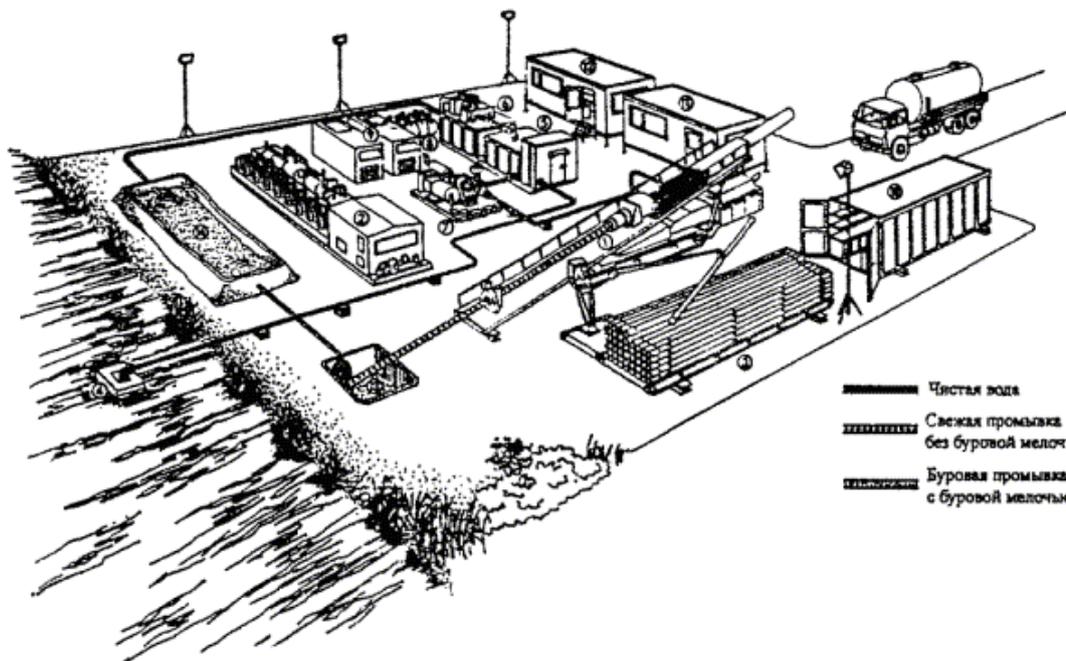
Схема размещения установки ГНБ на строительной площадке
